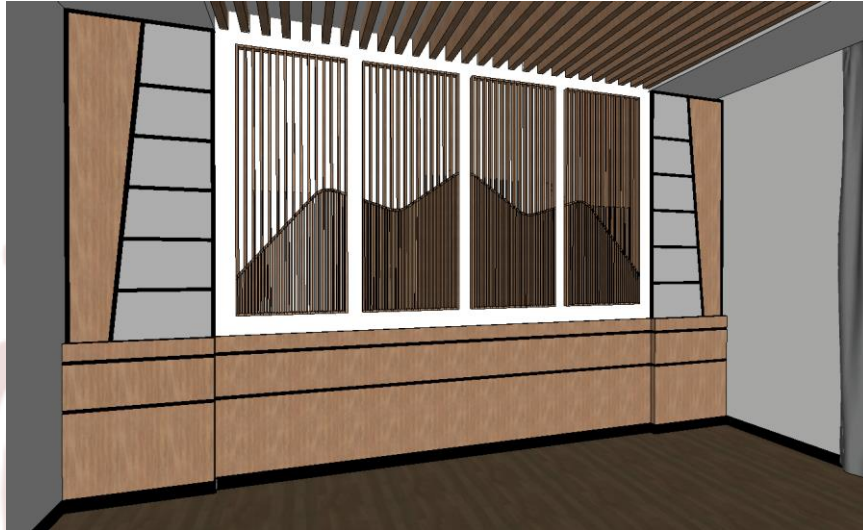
Alternatif 2 Rencana Dinding *Guest Room Standard Room
